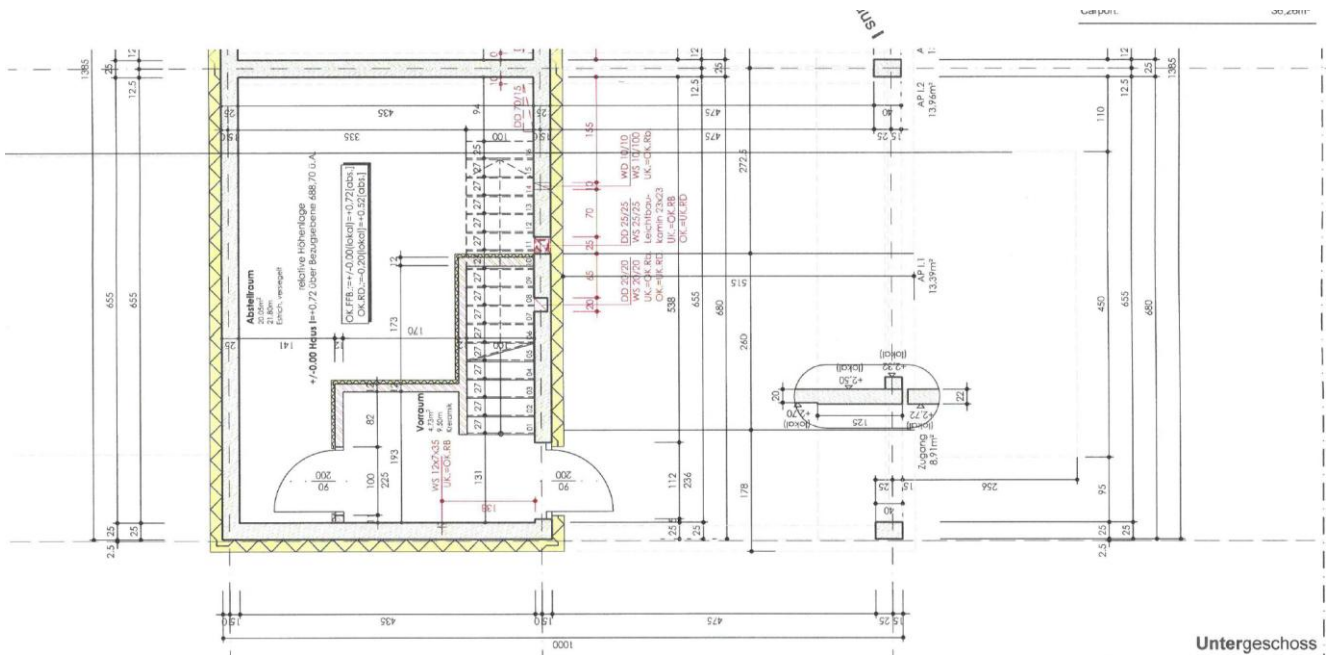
Grundriss Untergeschoss Reihenhaus Top I1 gem. Nutzwertgutachten v. 17.04.2018¹⁵
